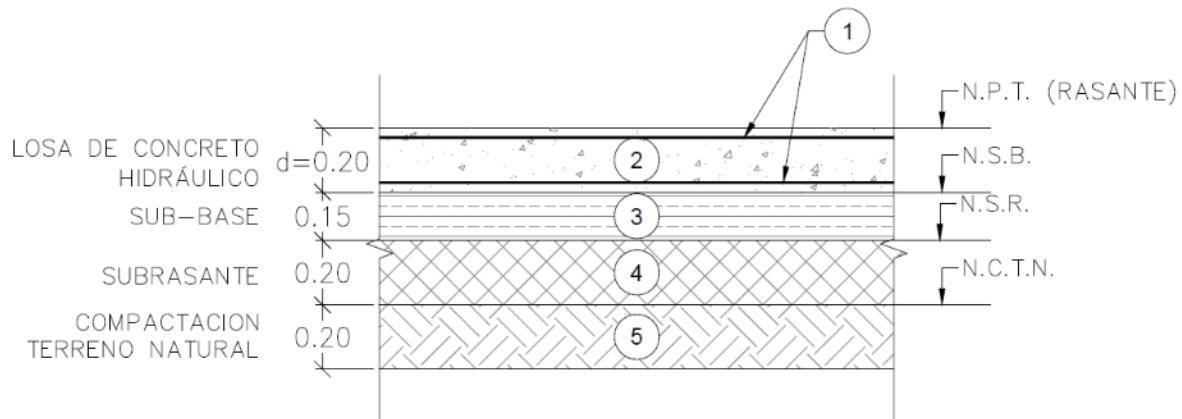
Sección tipo para la construcción de la losa de concreto
